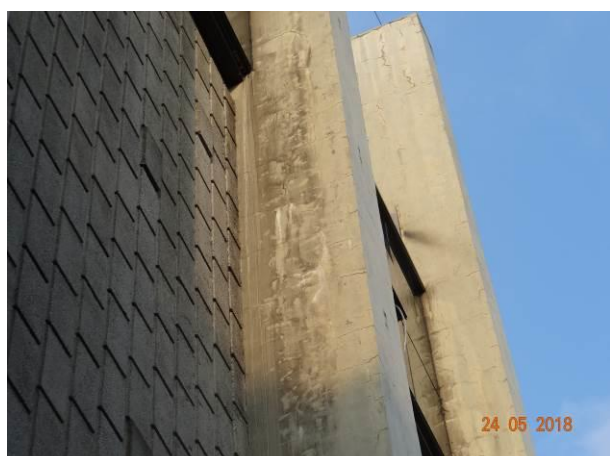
Fissuras aleatórias na face Norte do pilar P71.
